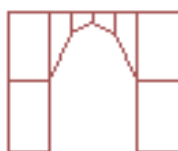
Sección discretizada de los arcos longitudinales de cimentación
